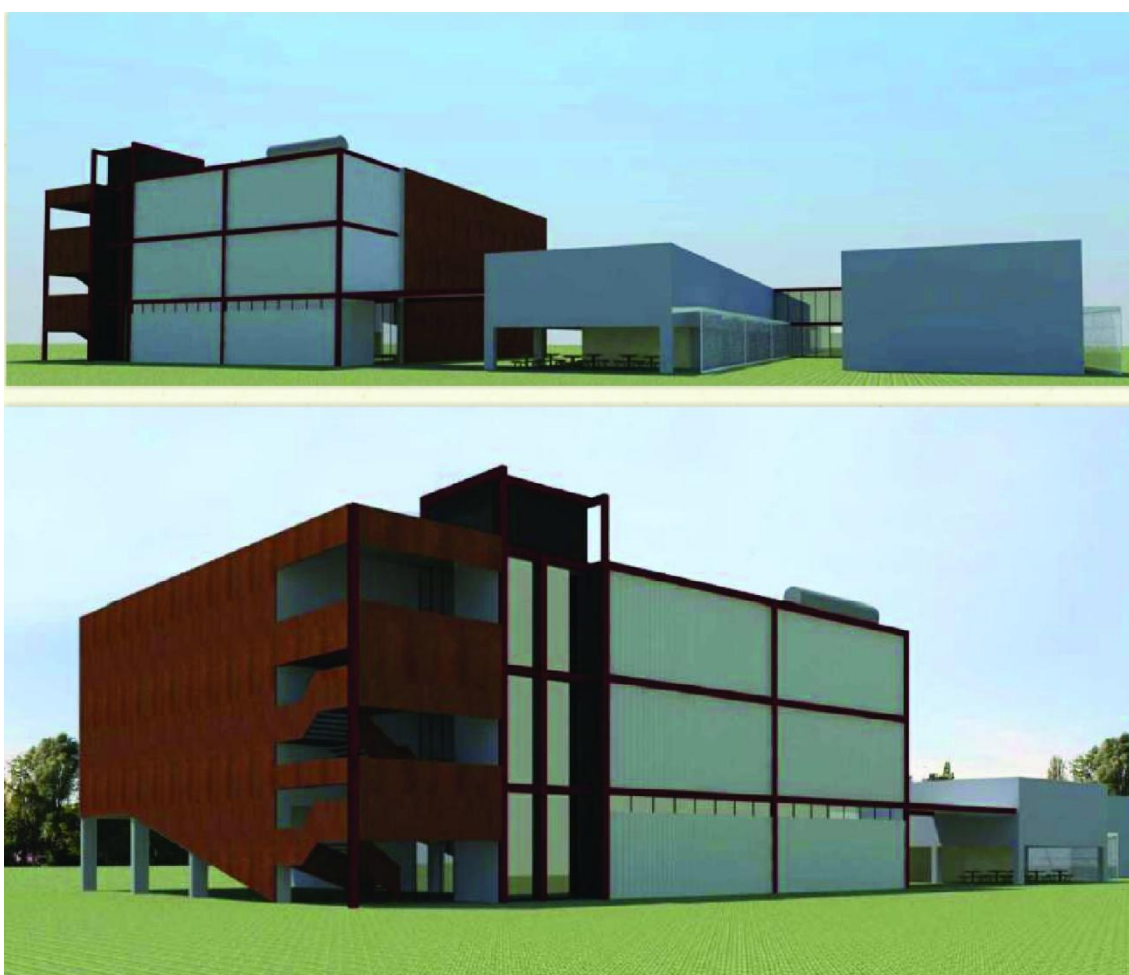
Plano Diretor – Futuras instalações do MHNJB
